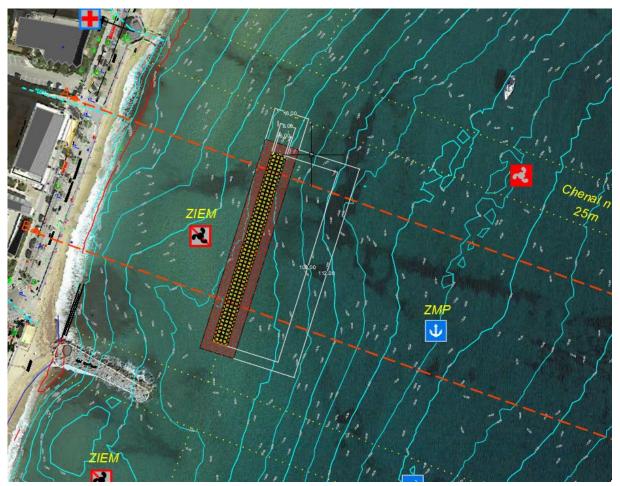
Vue en plan du brise-lames en gabions et géocorail sur la plage du Centre-Ville
